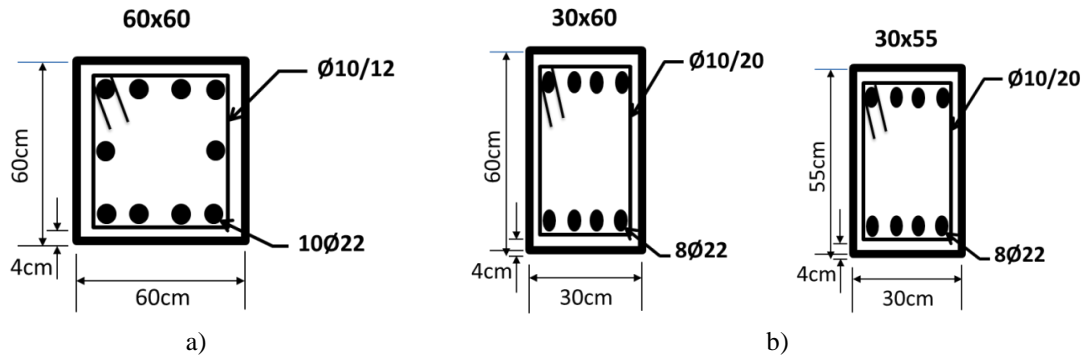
a) sección de columnas y b) sección típica de vigas Nivel 1
